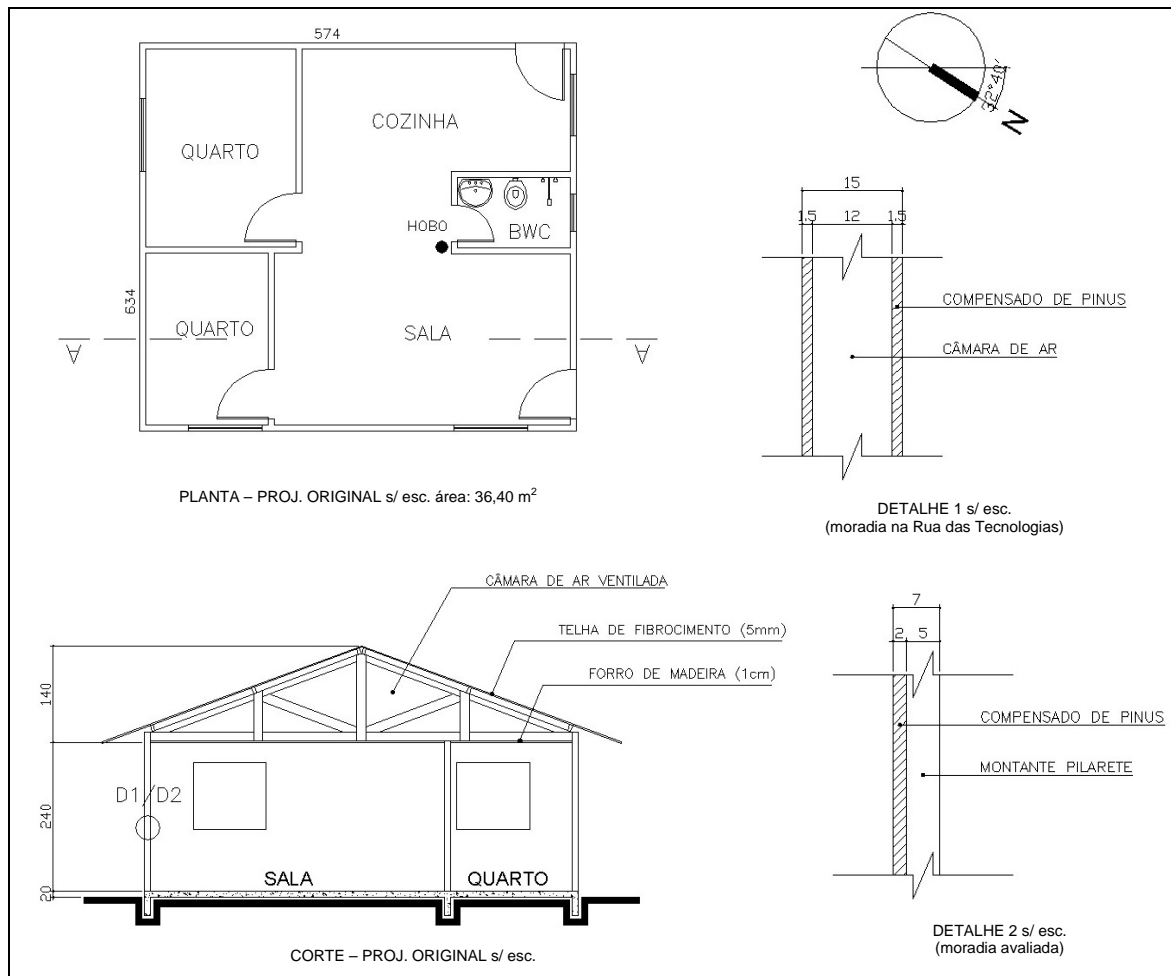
Planta, corte e detalhes do sistema construtivo Batistella (DUMKE, 2002)
